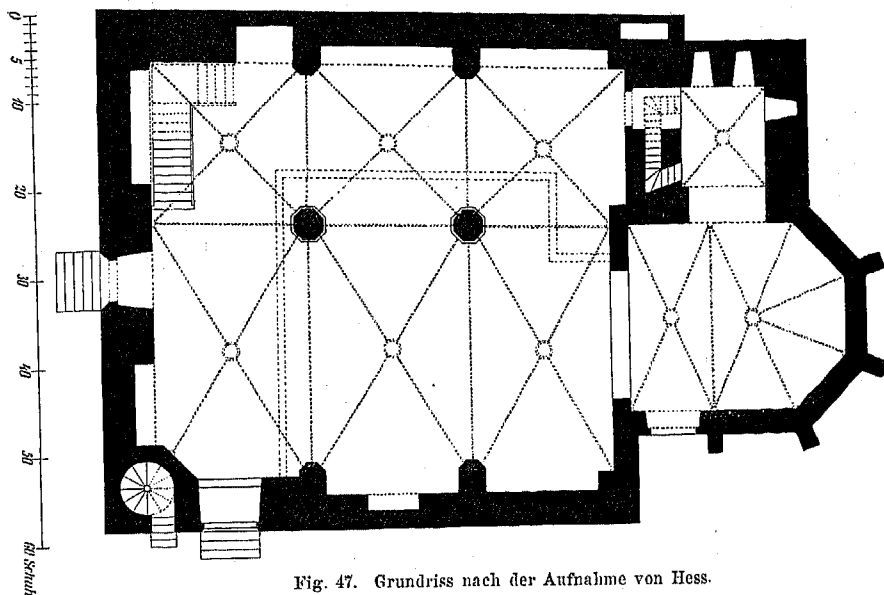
Grundriss nach der Aufnahme von Hess.
